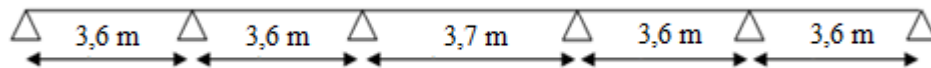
Types de poutrelles dans le plancher pour exemple de calcul .
